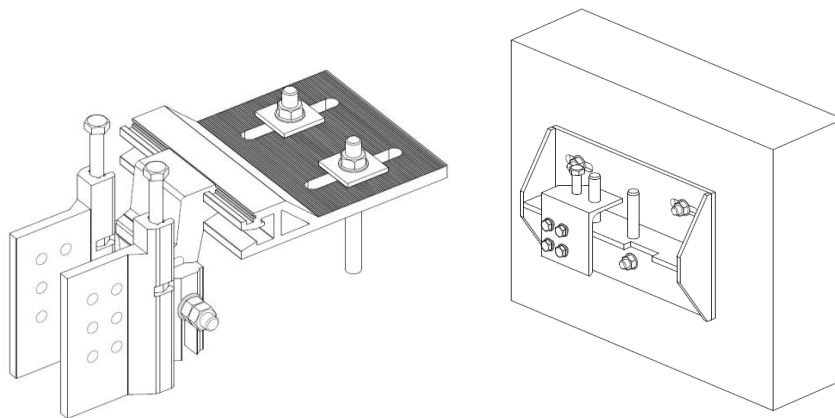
Кронштейн для крепления модулей к перекрытию или стене.
